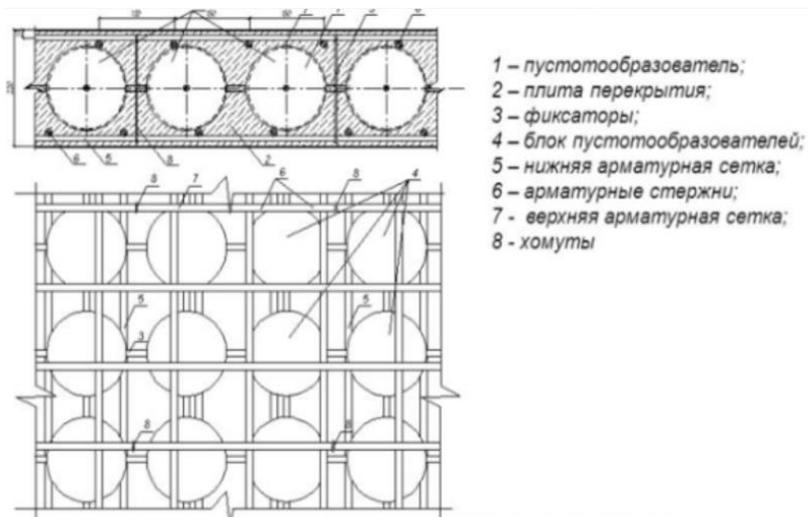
Схема устройства блока пустообразователей в плиту перекрытия
